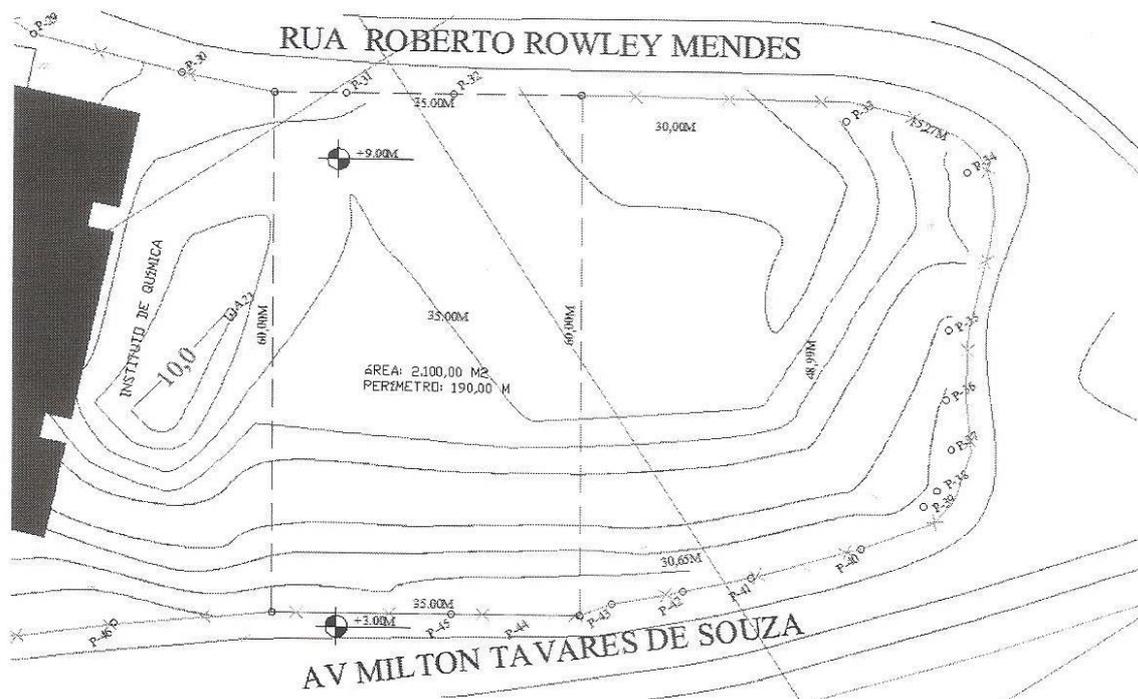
Planta de Situação do Terreno Proposto para exercício de projeto .
